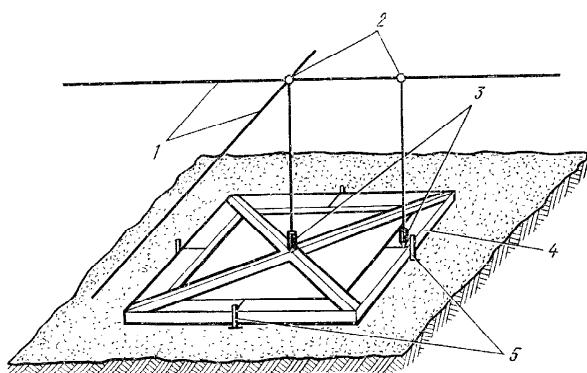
Разметка места установки отдельностоящего фундамента под колонну:
